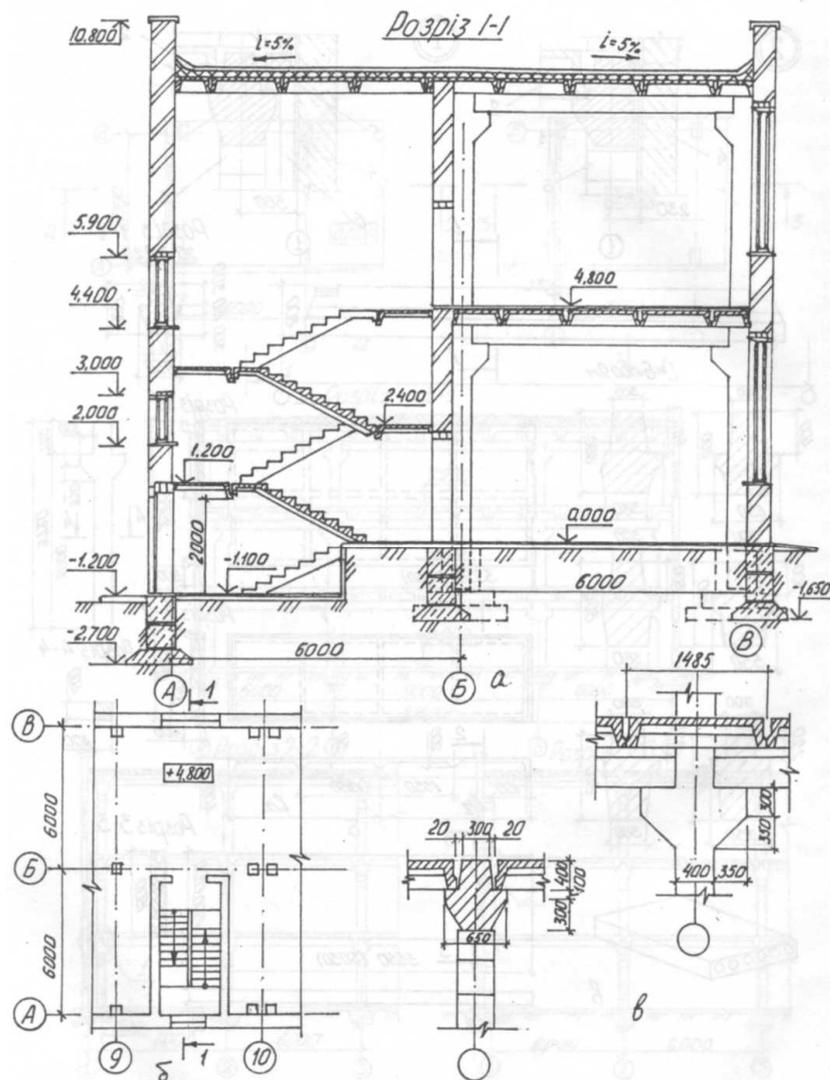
Двоповерхова промислова будівля з балочними перекриттями:
